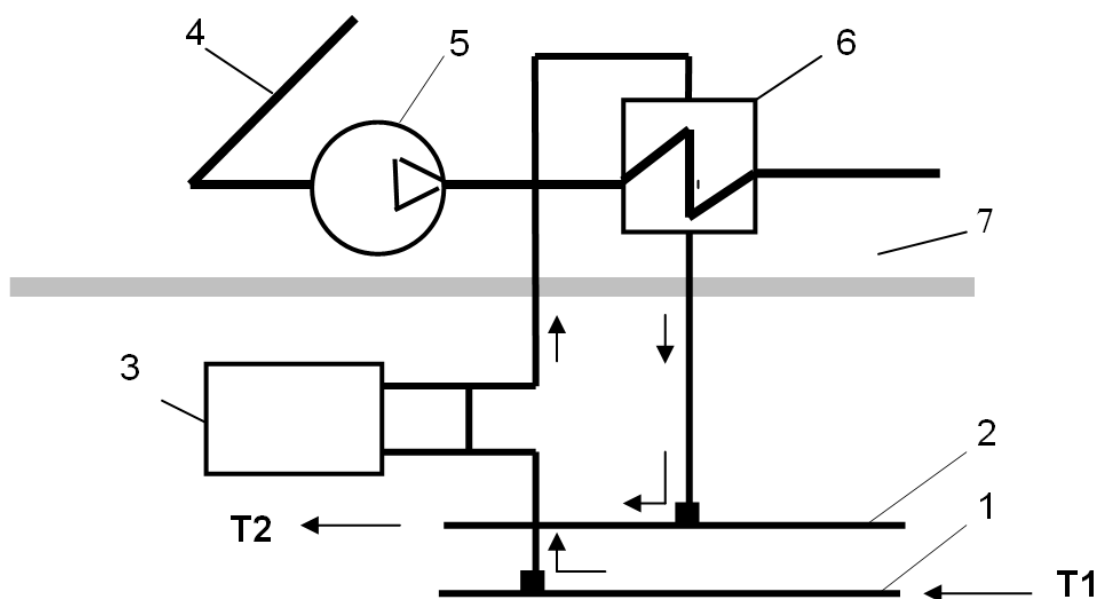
Схема отопления здания с трубопроводом оттаивания
